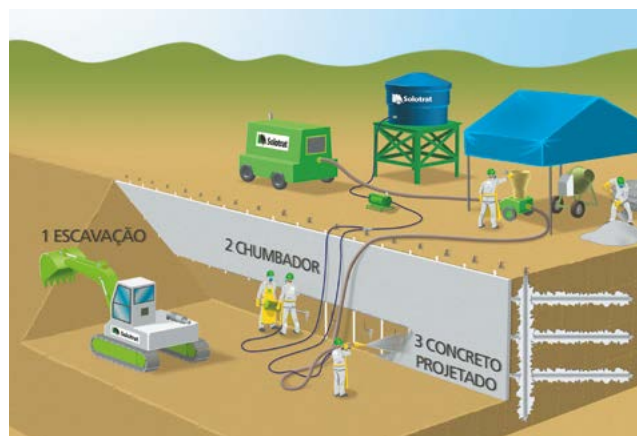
Fases construtivas em corte. Exemplo de escavação mecanizada.
